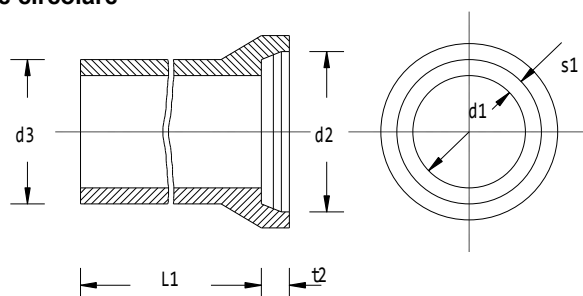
tubi in calcestruzzo di sezione circolare con manicotto senza piede
